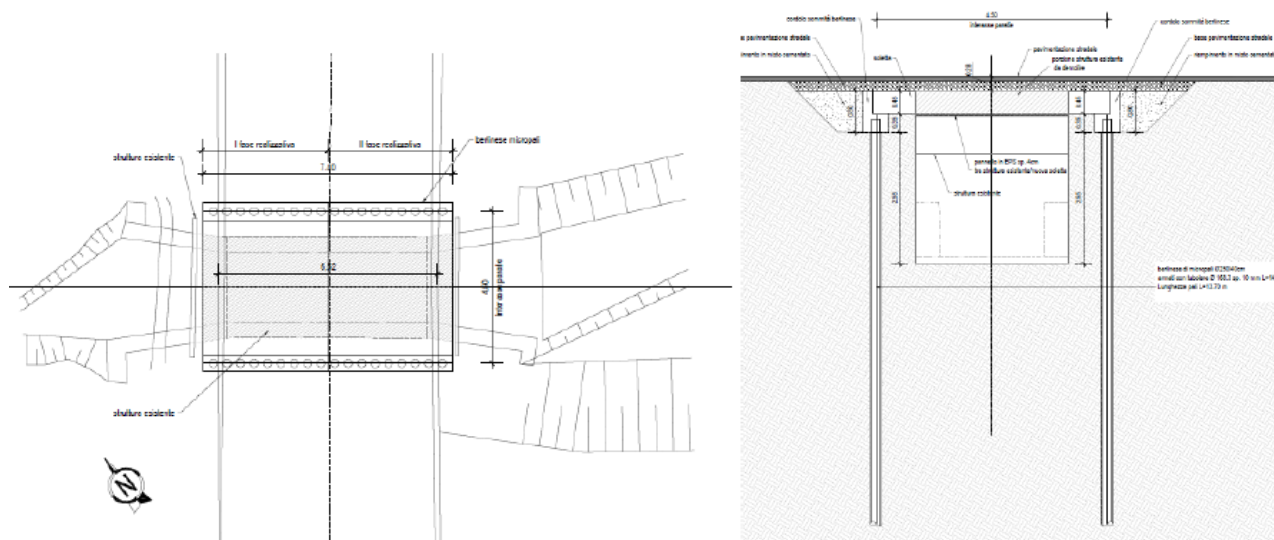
Planimetria e sezione di progetto attraversamento idraulico al km 58+700 della SS 14 (Fonte: All. 3 alla Lista di Controllo – Relazione Tecnica Generale)
